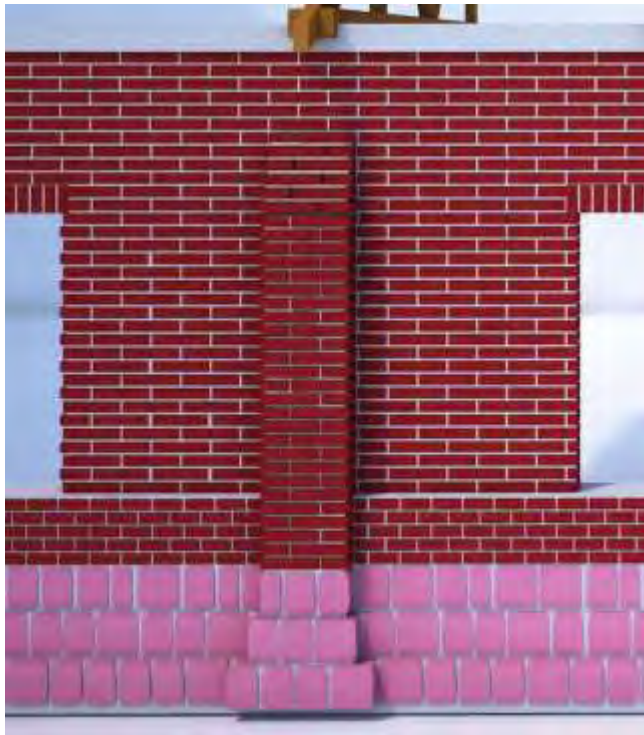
Representación de muro de ladrillo, con cimentación expuesta, sin aplanado para mostrar la disposición del ladrillo y de la piedra.
